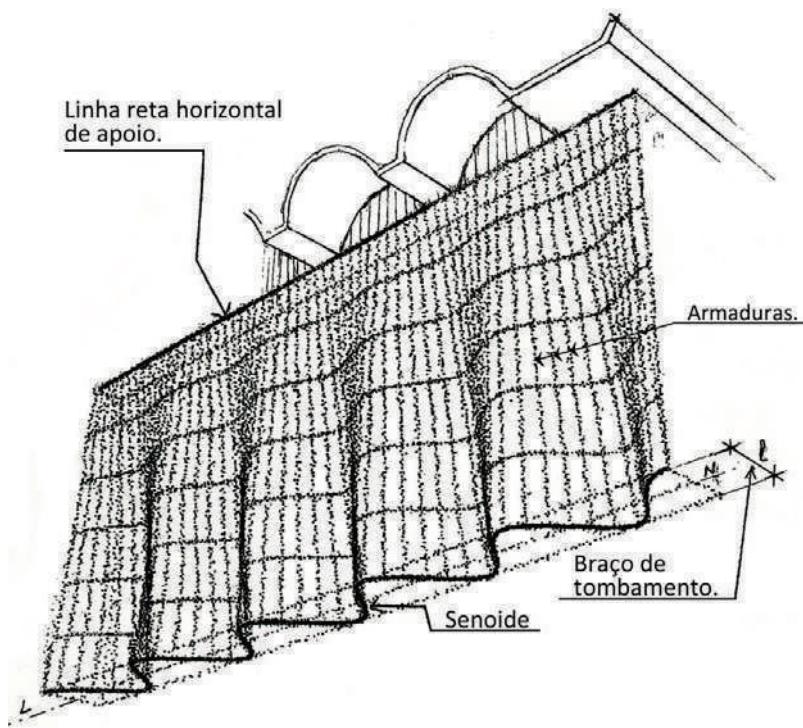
Vista de baixo para cima. Esquema da geometria da parede onde a base é uma senoide e o topo é uma reta horizontal, unidos por linhas retas. Na construção serão as armaduras. (*-5).
